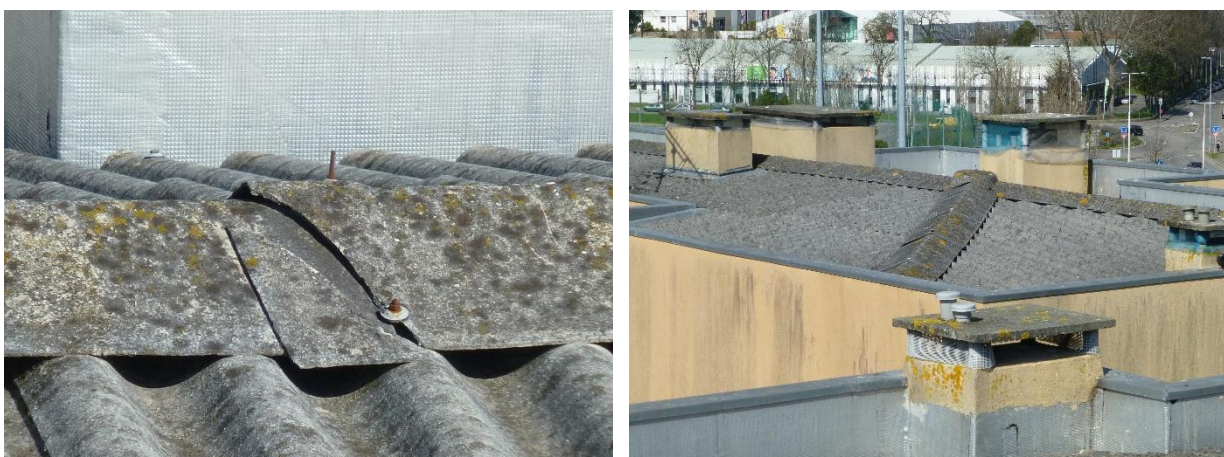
Fissuração pontual das placas de fibrocimento
